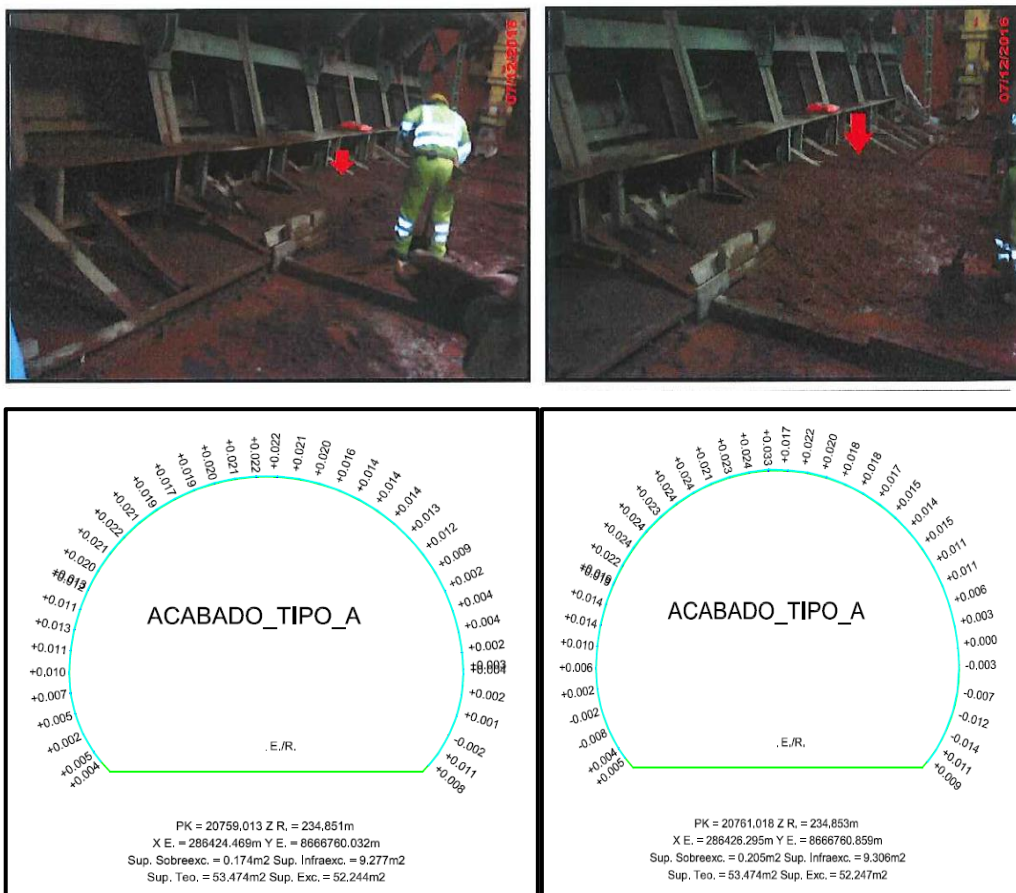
Vista de la observación al muro guía construido en el tramo del túnel, también se muestra el levantamiento topográfico a la sección de túnel
